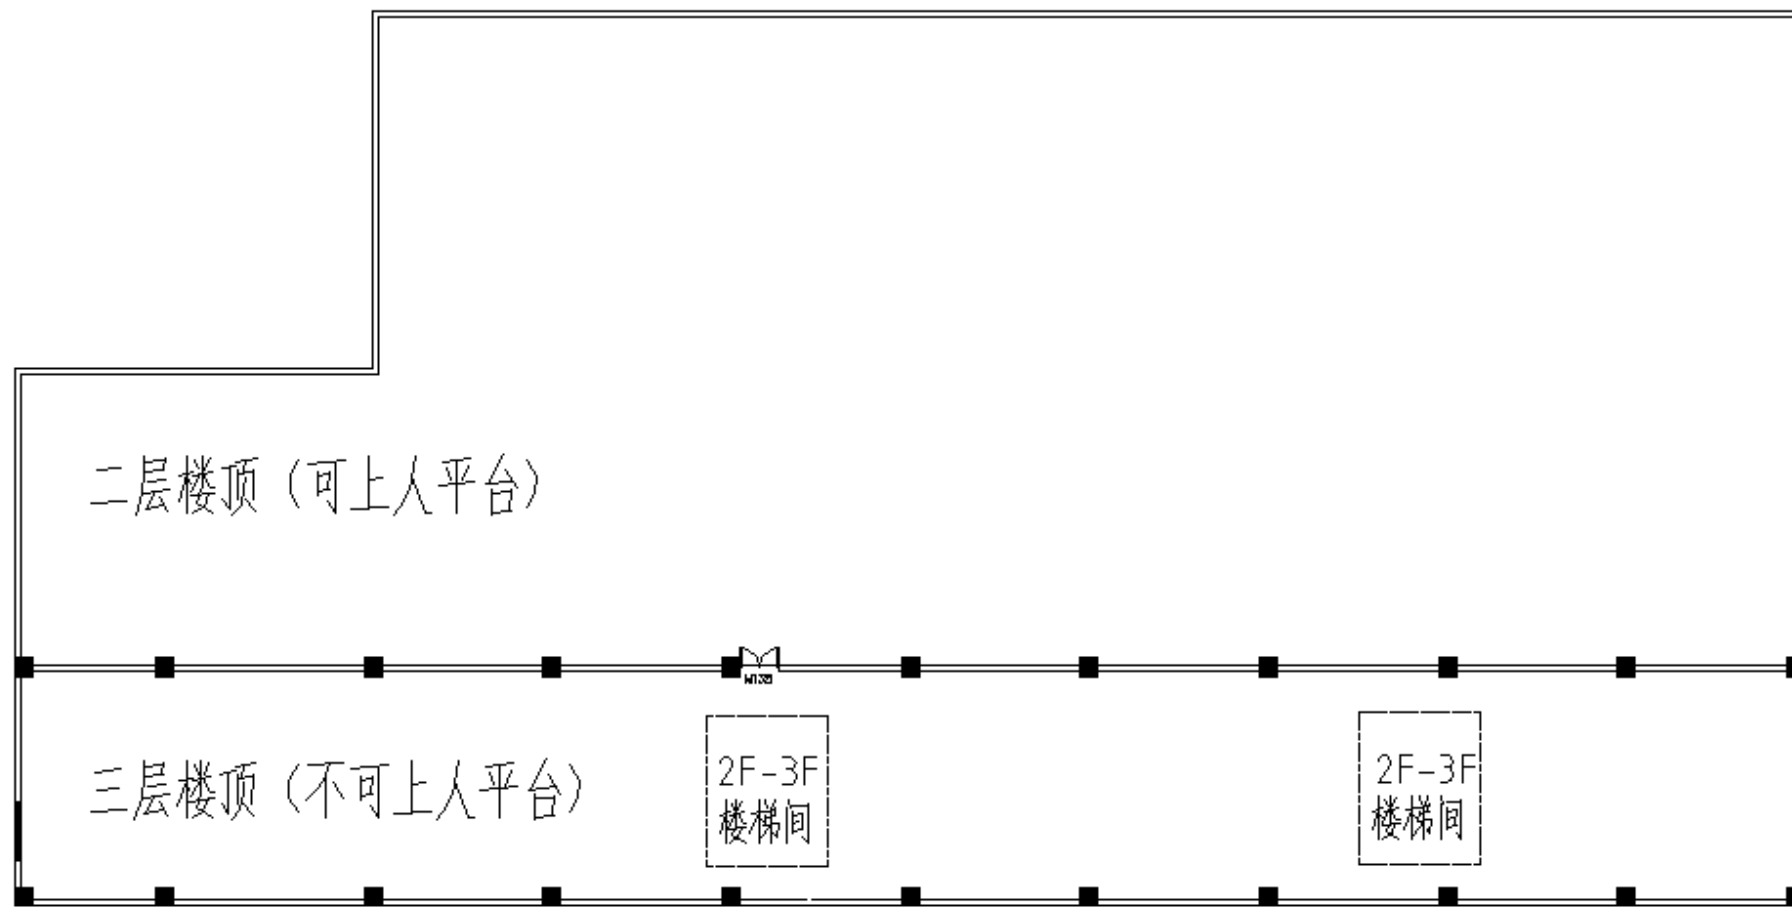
生猪屠宰车间 3 楼平面布置图
